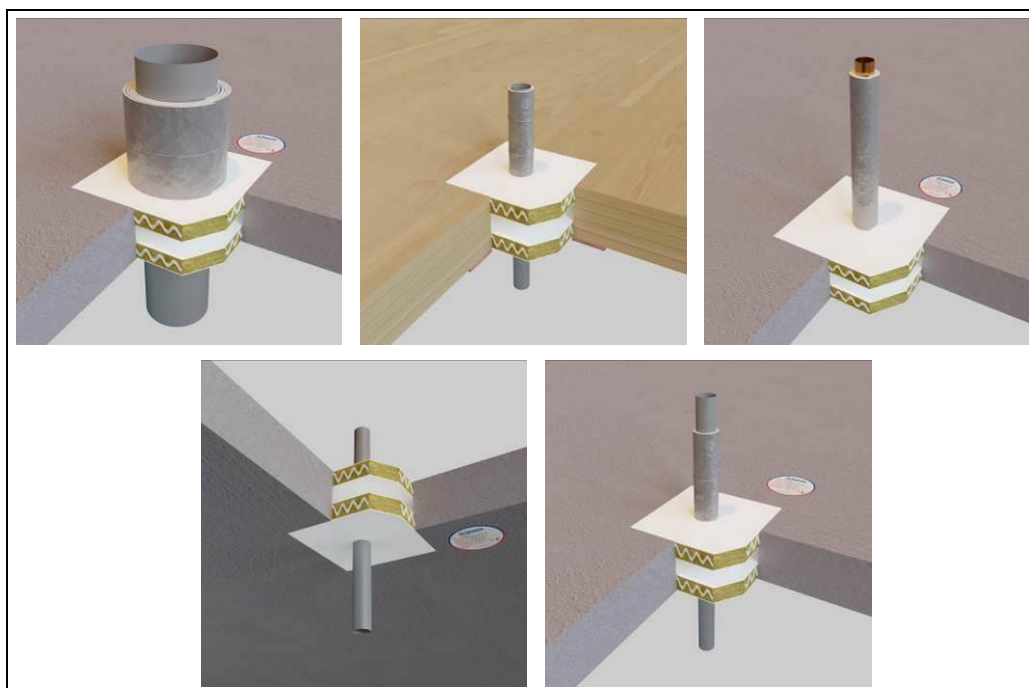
Exemple de joint de tuyaux métalliques non isolés dans les planchers.
